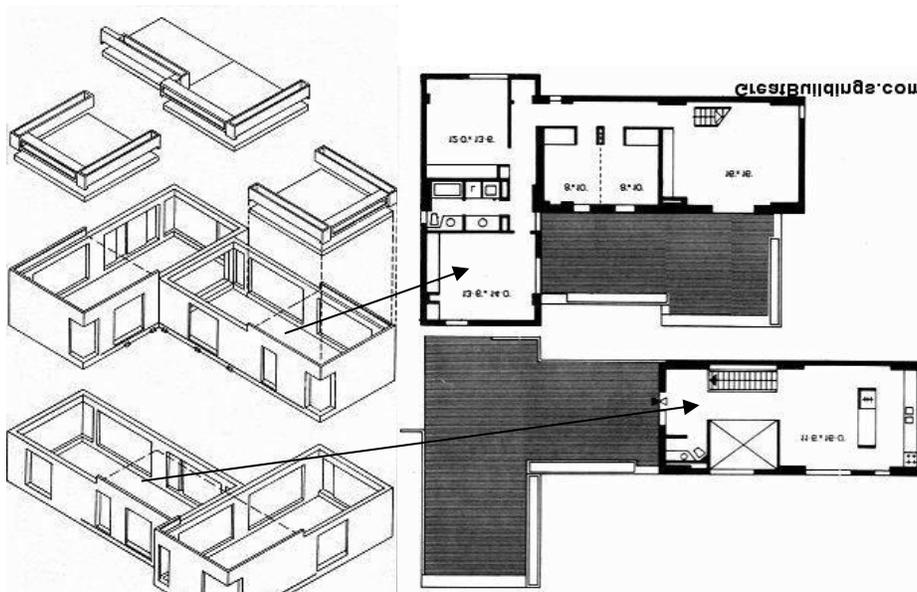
Distribución en planta de los departamentos, demostrando como el departamento de una planta más baja, sirve de terraza.
